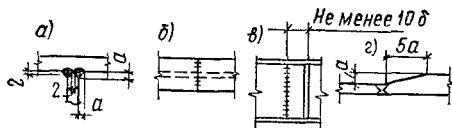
Сварные стыки подкрановых балок
